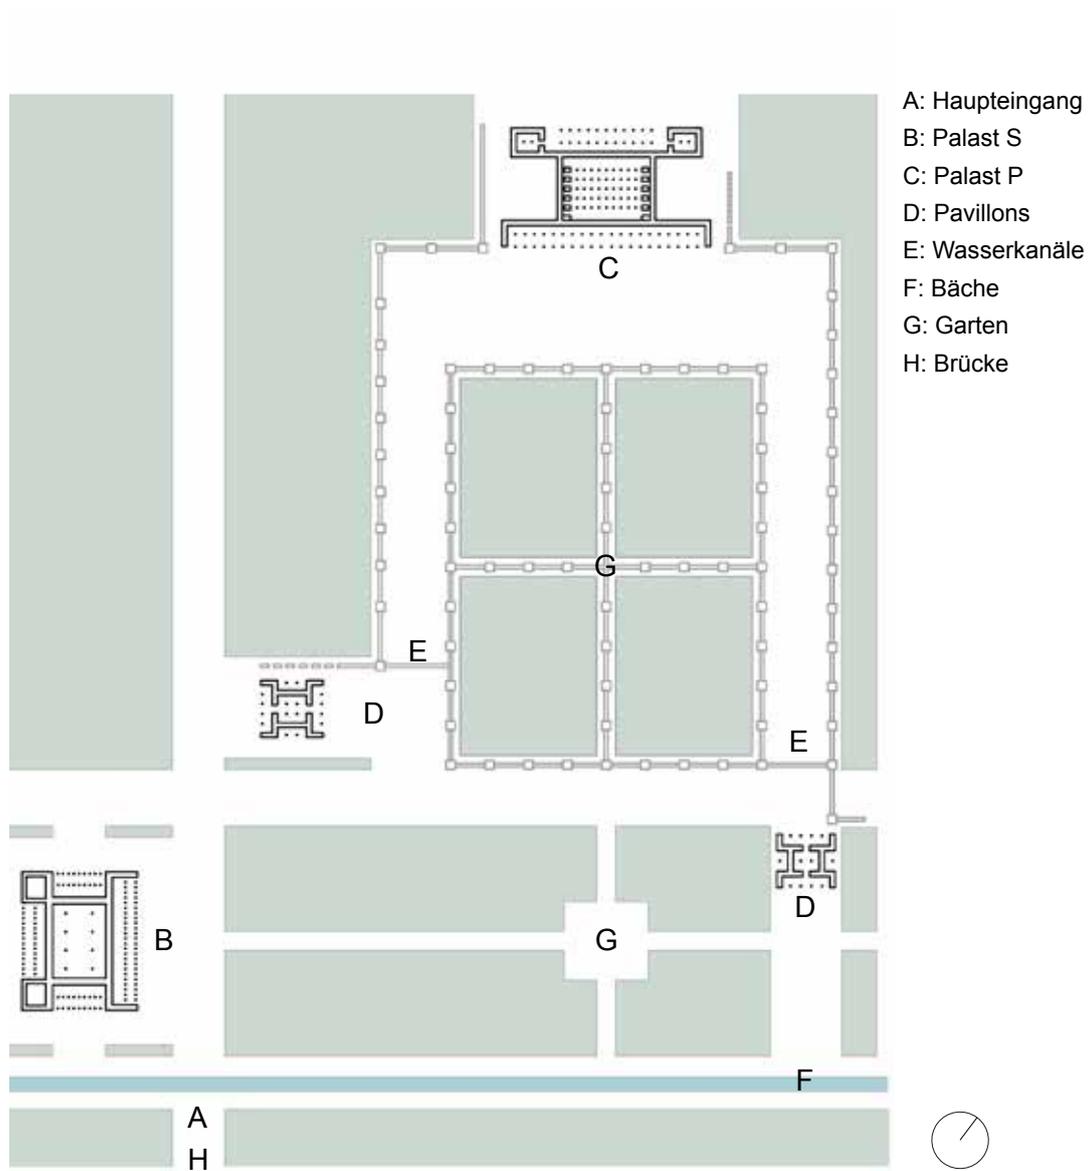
Grundriss des Palastgartens der Kyros-Residenz in Pasargadae.
